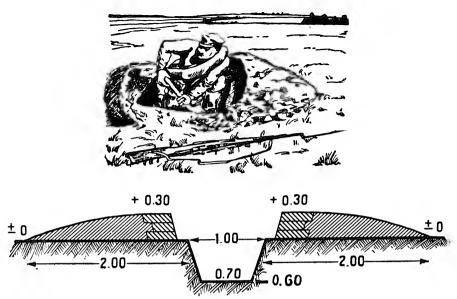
Вверху — отрывка ячейки для стрельбы с колена. Внизу — профиль окопа для стрельбы с колена.
